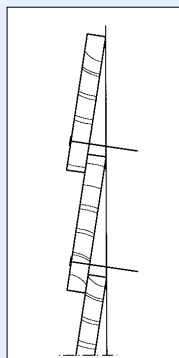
Zichtbare bevestiging van smalle planken : één enkele bevestiging per steunpunt, op ongeveer 15 mm van de onderrand van de planken
